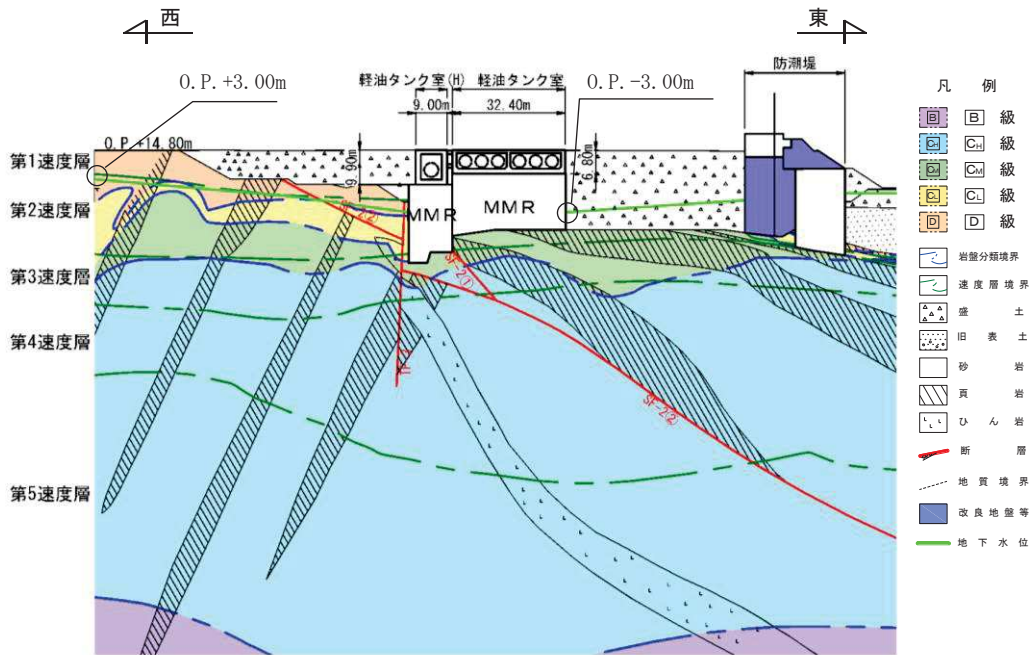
軽油タンク室 地震時荷重算出用地質断面図 (B-B 断面, 東西 (タンク室))
